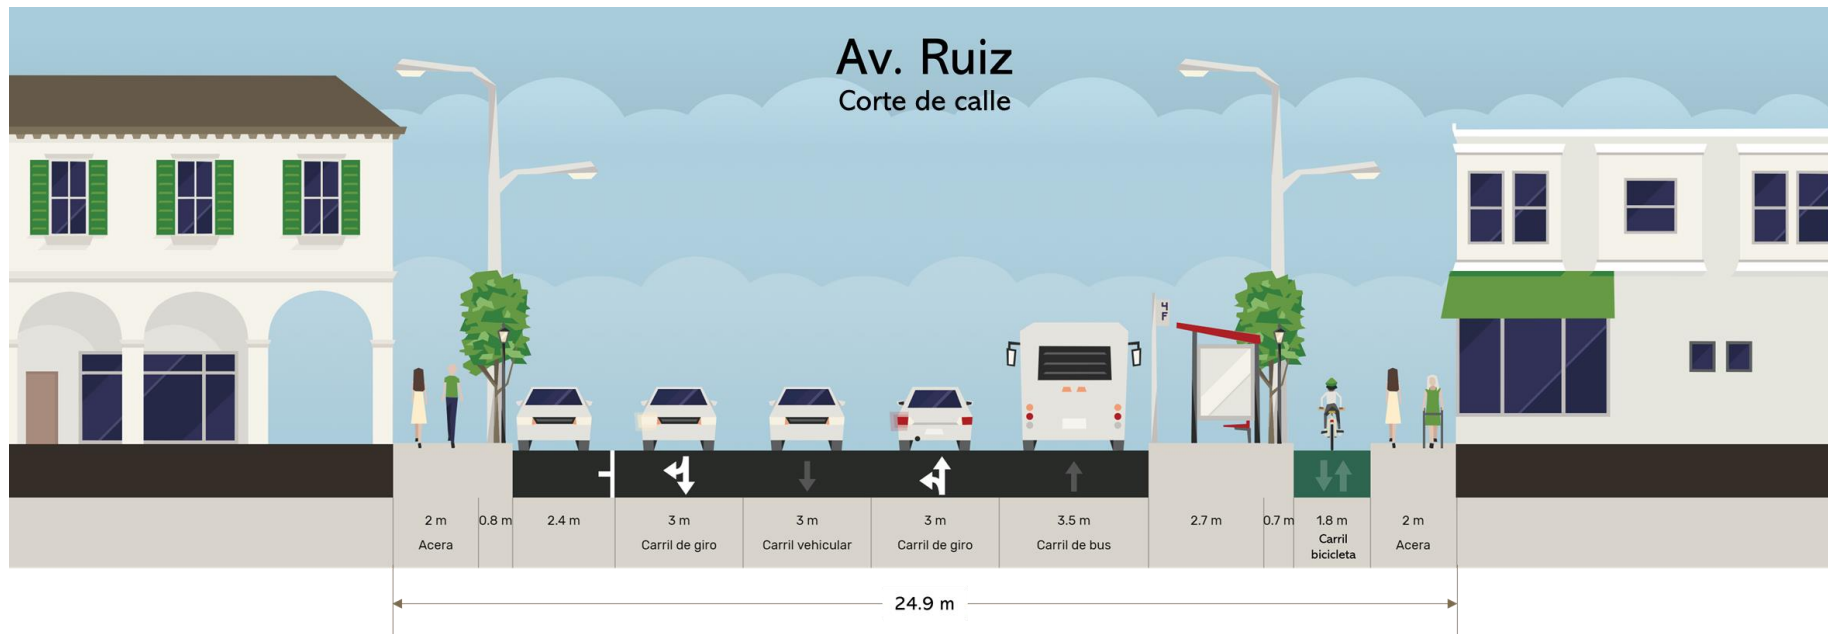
Detalle distribución de propuesta para avenida Ruiz (corte).
